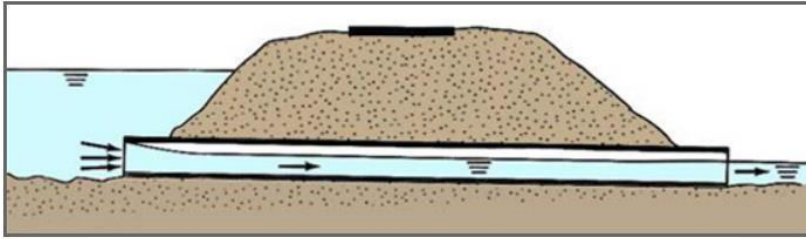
Flujo en una alcantarilla bajo condiciones supercríticas, con la entrada sumergida y la salida no sumergida.
